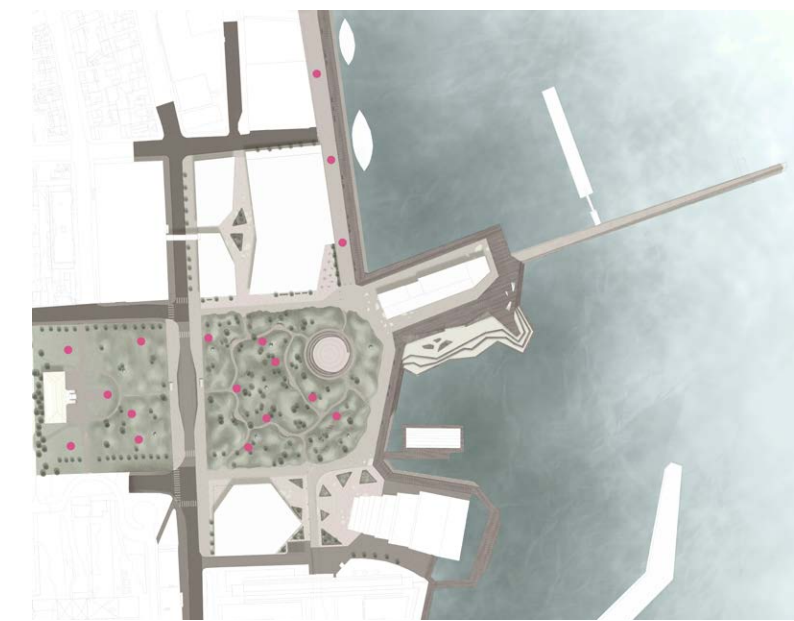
Betong skal brukes på den indre delen av havnepromenaden, samt som yttre kant der båter legger til. Lys betong brukes på bryggekonstruksjonen.
